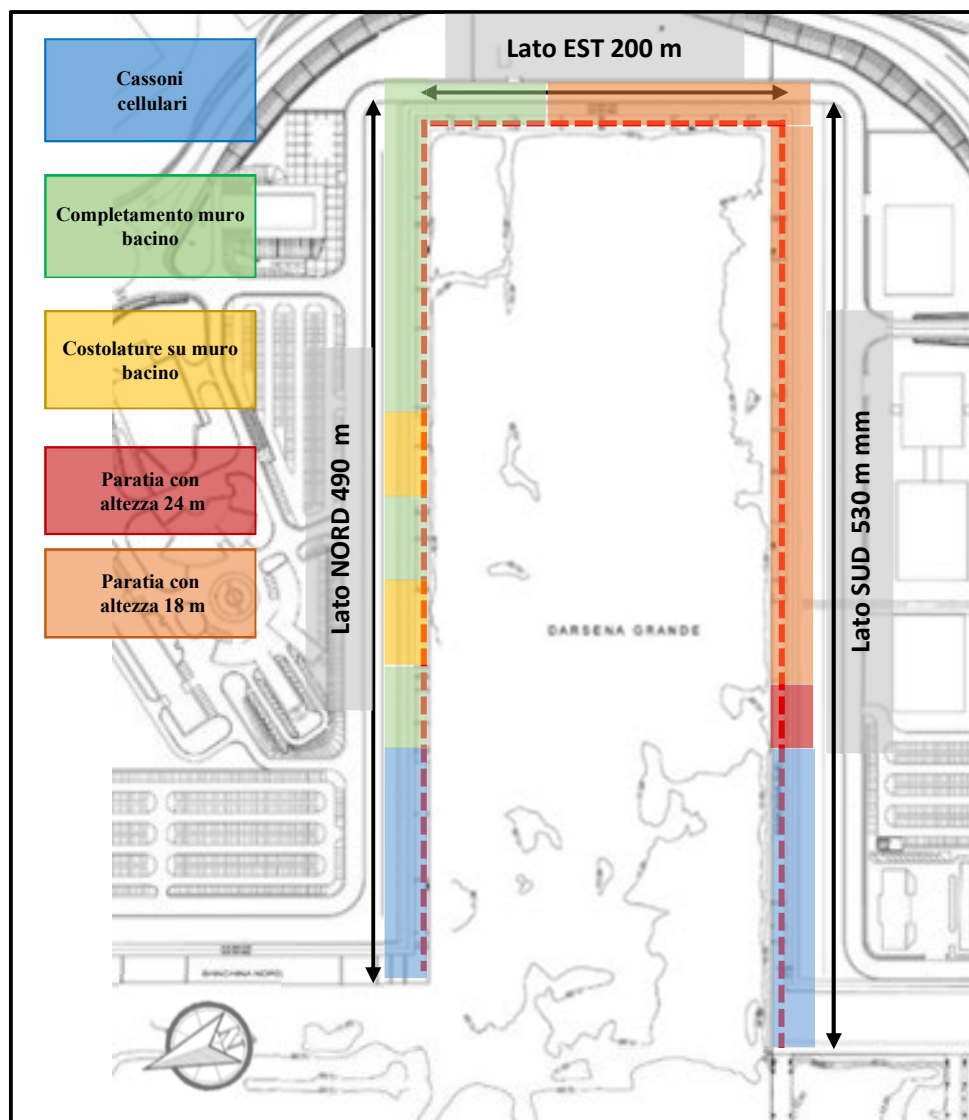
Planimetria Consolidamenti banchina Darsena Grande
